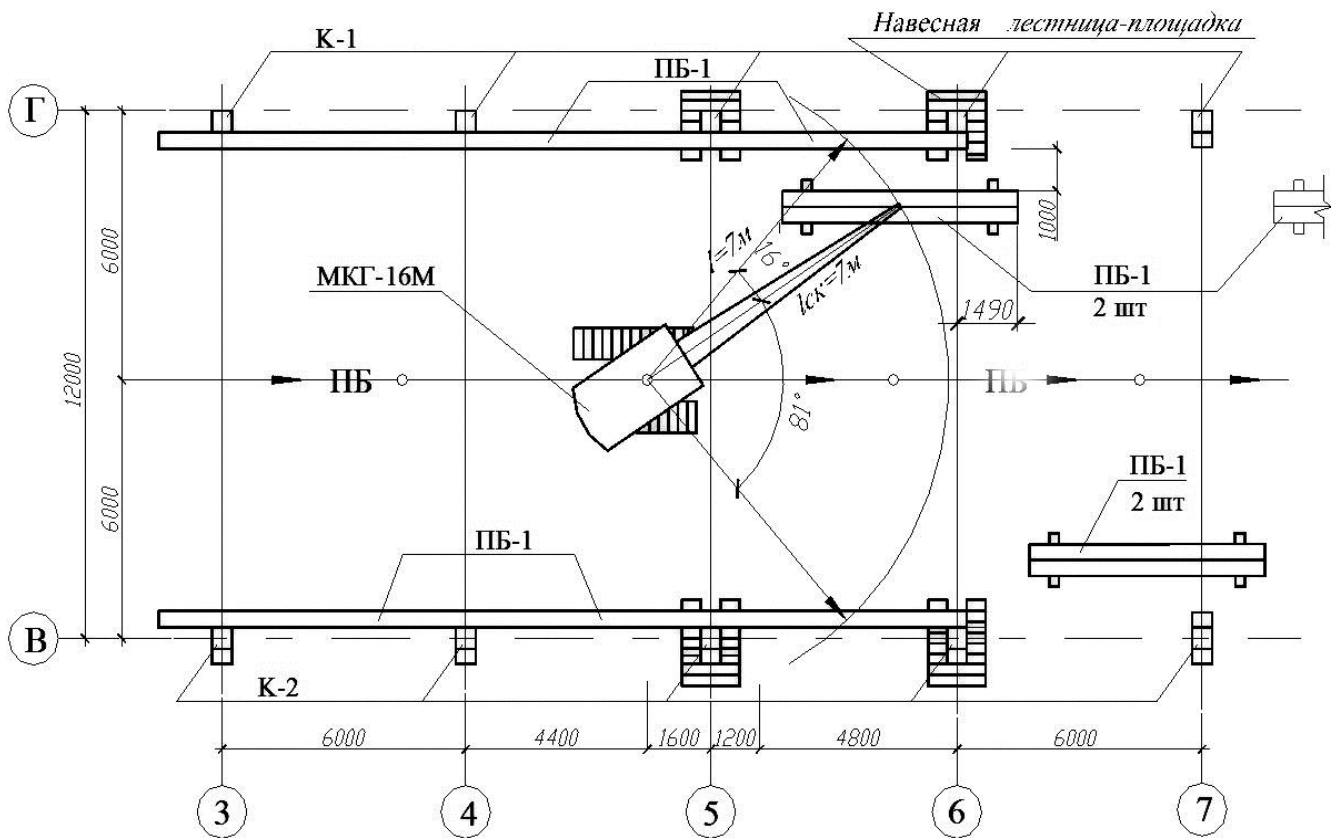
Схема монтажа подкрановых балок поворотом стрелы крана
